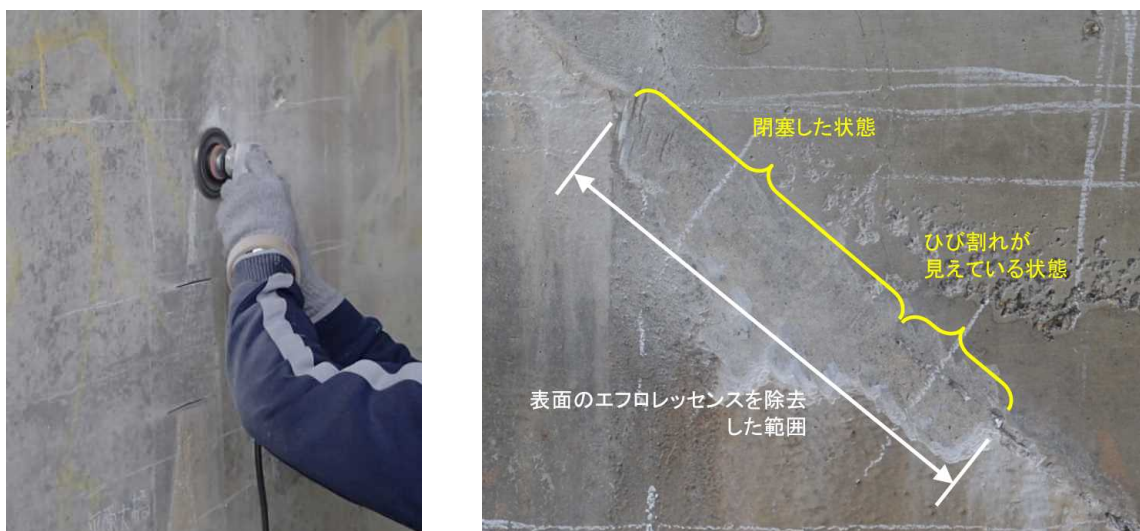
析出物の除去状況と削り粉でひび割れ表面が閉塞した事例
